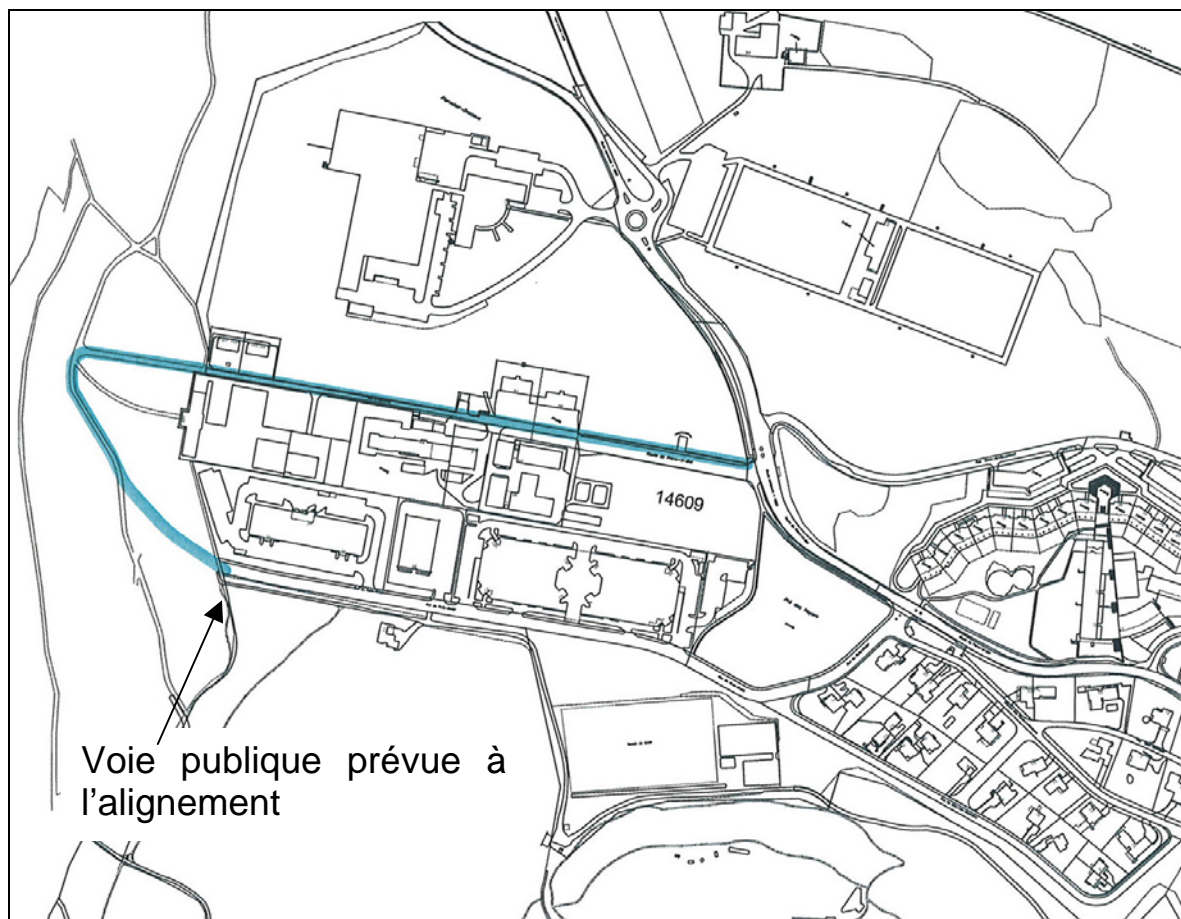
développement du plan d'alignement n° 100 « Pierre-à-Bot dessous »
